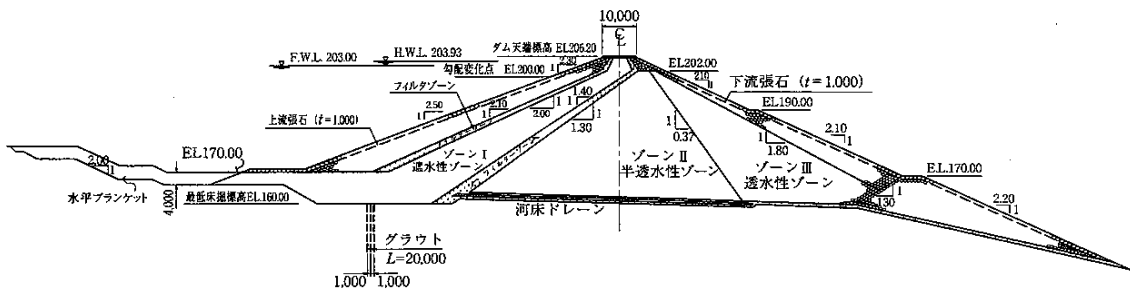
傾斜遮水ゾーン型フィルダムの事例（後川内ダム）
